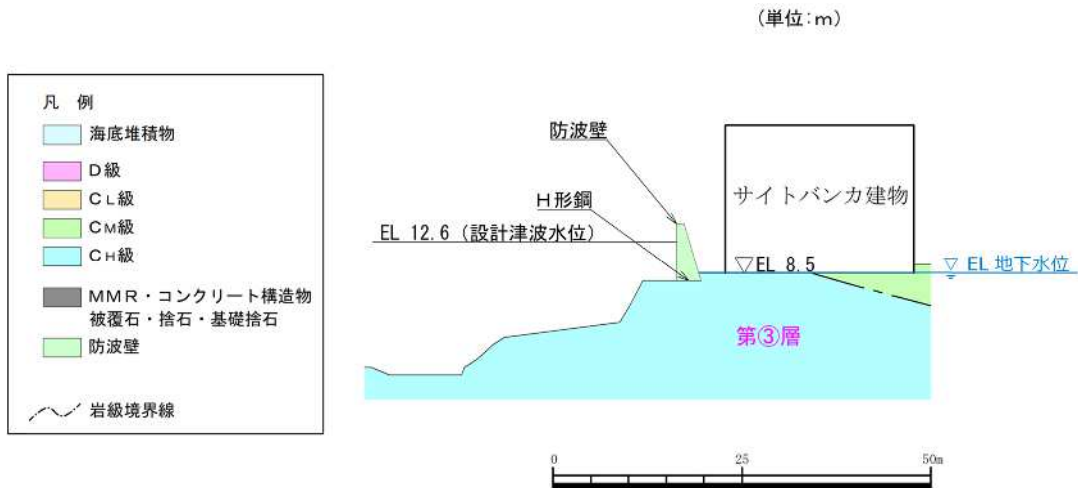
防波壁（波返重力擁壁）の横断面図
